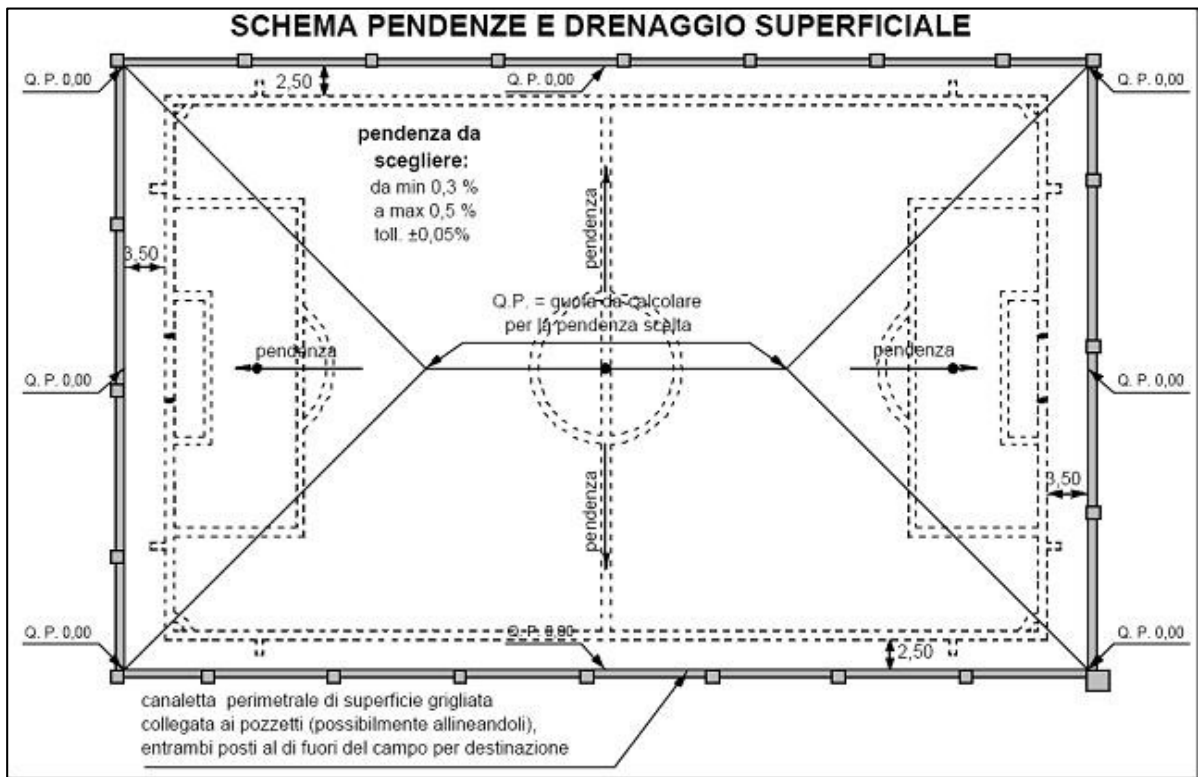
Planimetria con schema delle pendenze e drenaggio superficiale
